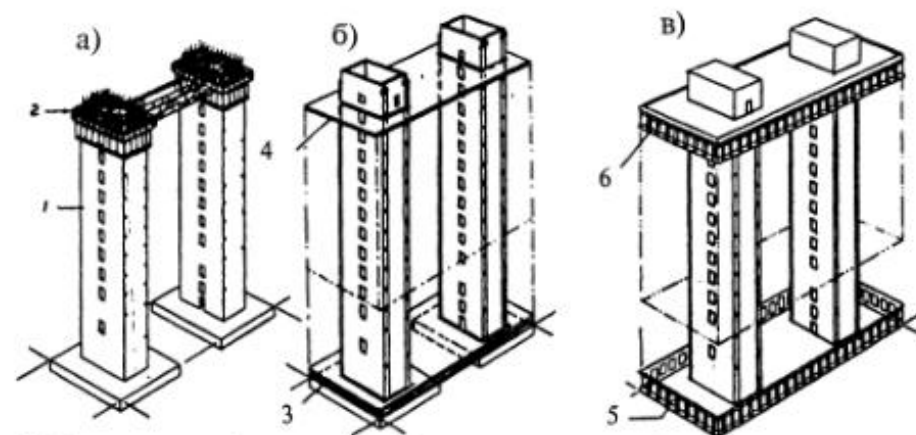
Схема конструкций монолитных и сборно-монолитных зданий: а - монолитные стволы жесткости; б - схема конструкций здания, возводимого методом подъема перекрытий; в - то же, методом подъема этажей; 1 - ствол жесткости; 2 - скользящая опалубка; 3 - пакет монолитных плит перекрытий размером на здание; 4 - перекрытие в проектном положении; 5 - этаж перед подъемом, 6 - этаж в проектном положении
